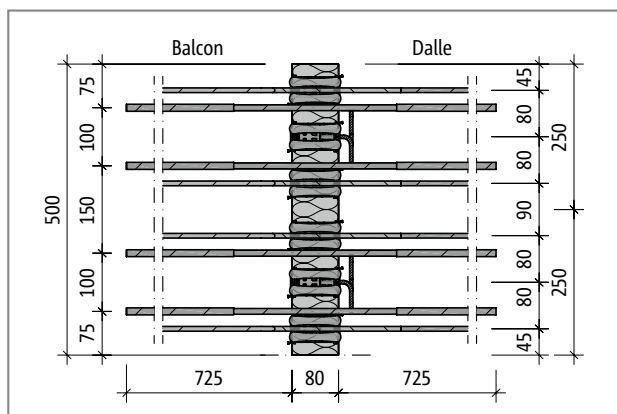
Schöck Isokorb® T Type K-E-M6 : Plan de base du produit de la variante L500
